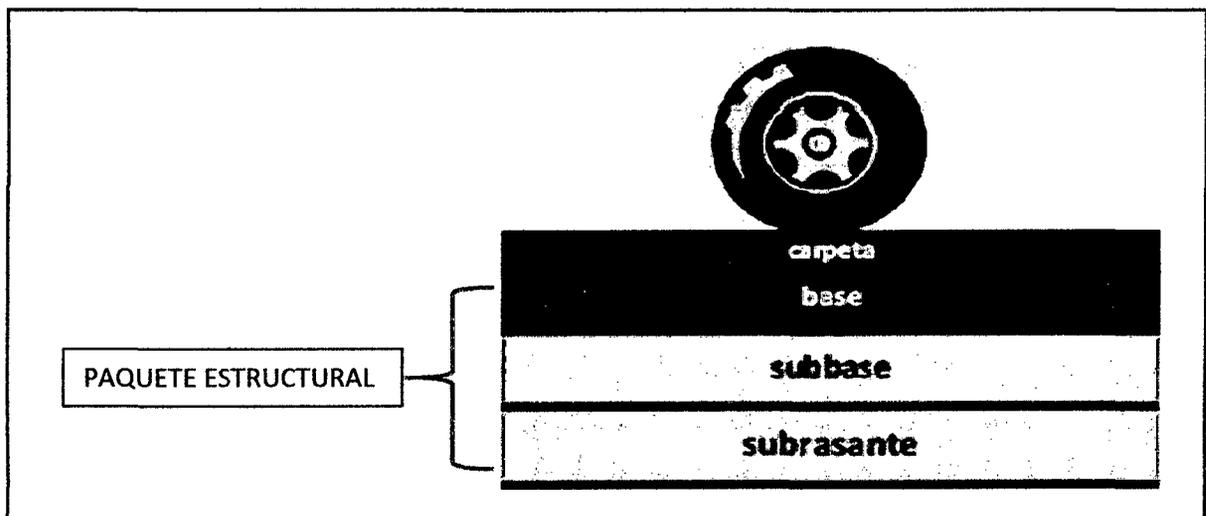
Esquema típico del paquete estructural de un pavimento flexible. (Fuente: Vásquez, 2002)
